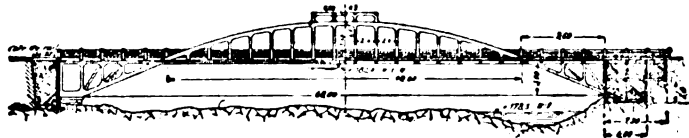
Ponte in cemento armato a La Mescia. Sezione longitudinale.
